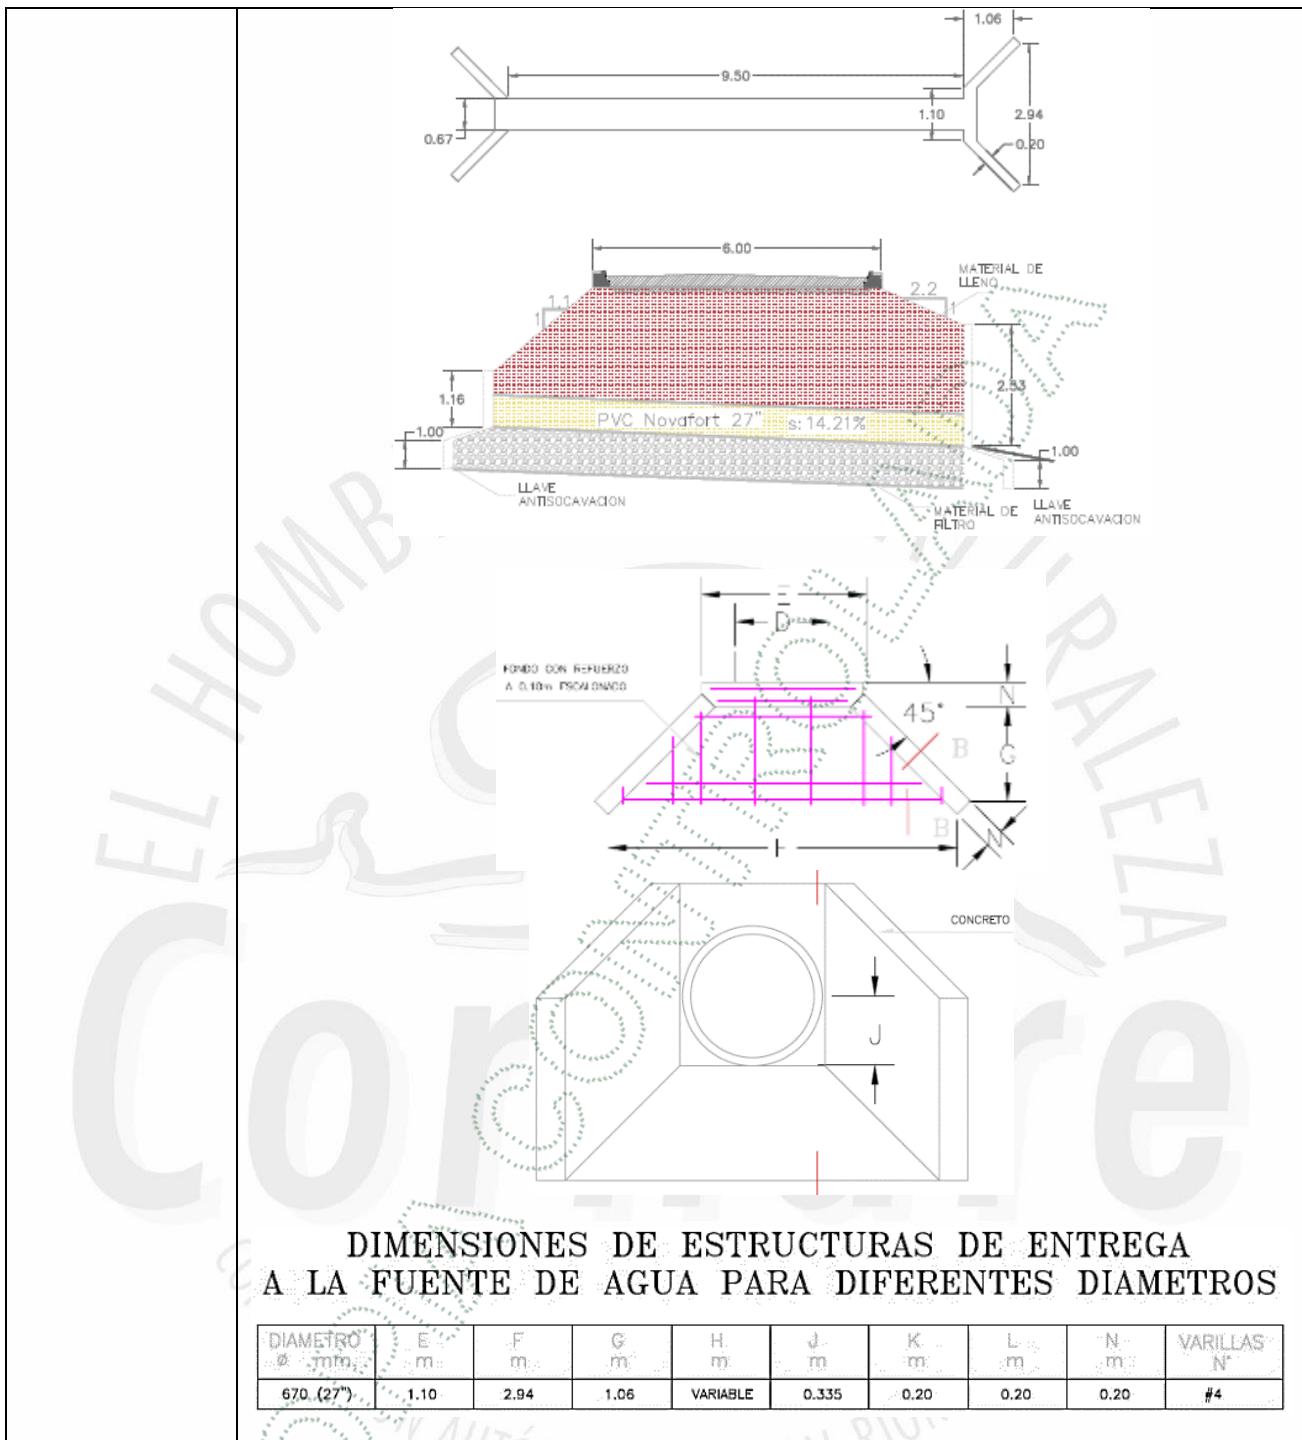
Tipo de la Obra:	Tubería Tubería 27" – Cruce vial N°2
